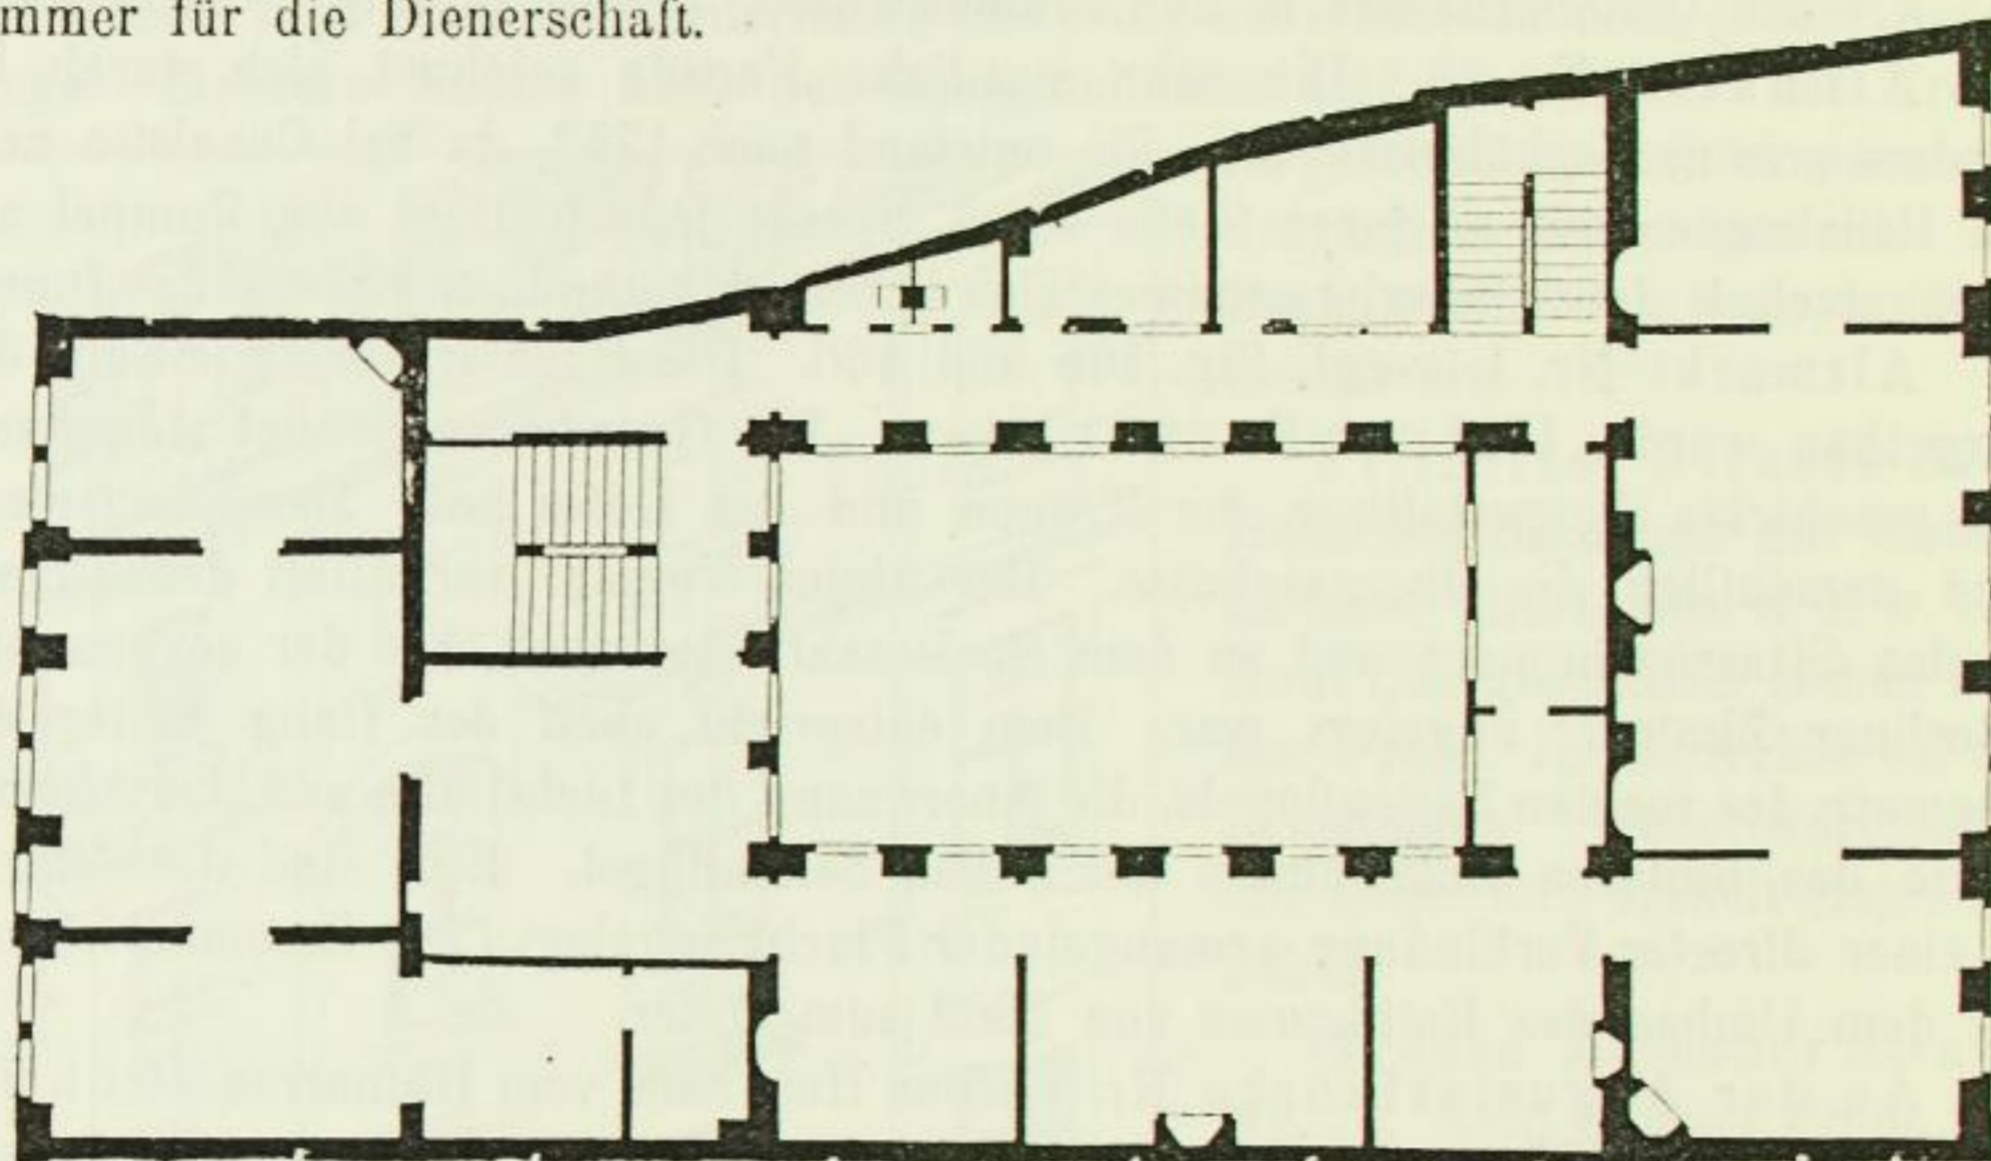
Klostergasse Nr. 4. Grundriss des Obergeschosses.
